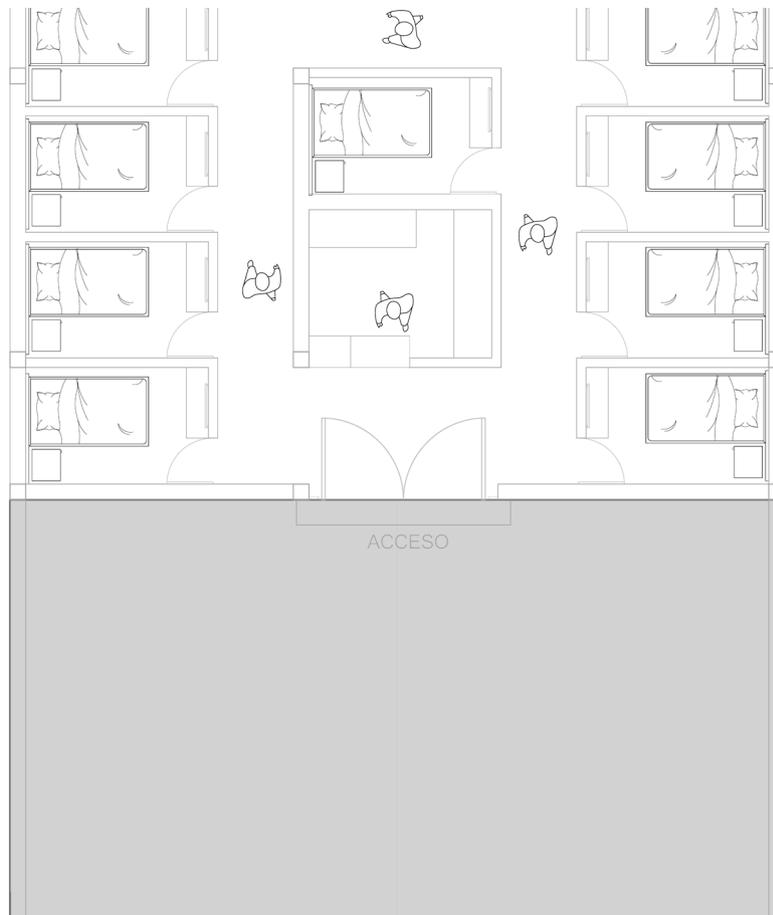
Planta de ubicación del área de acceso al centro de terapia.
